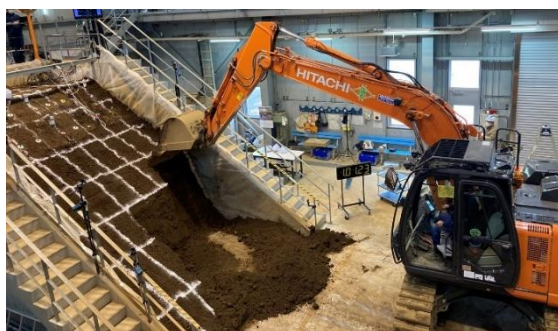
実大斜面実験 BH 掘削状況 (S3 掘削)
